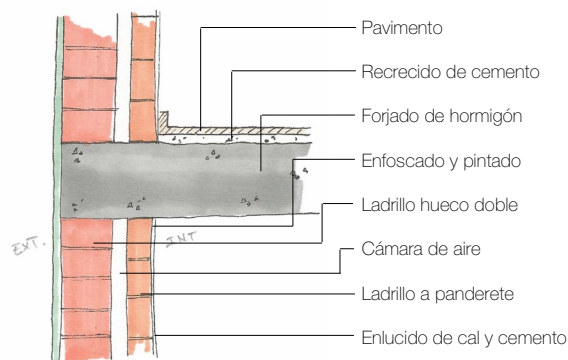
Detalle en sección de encuentro forjado con pared de fachada (autoría propia).
